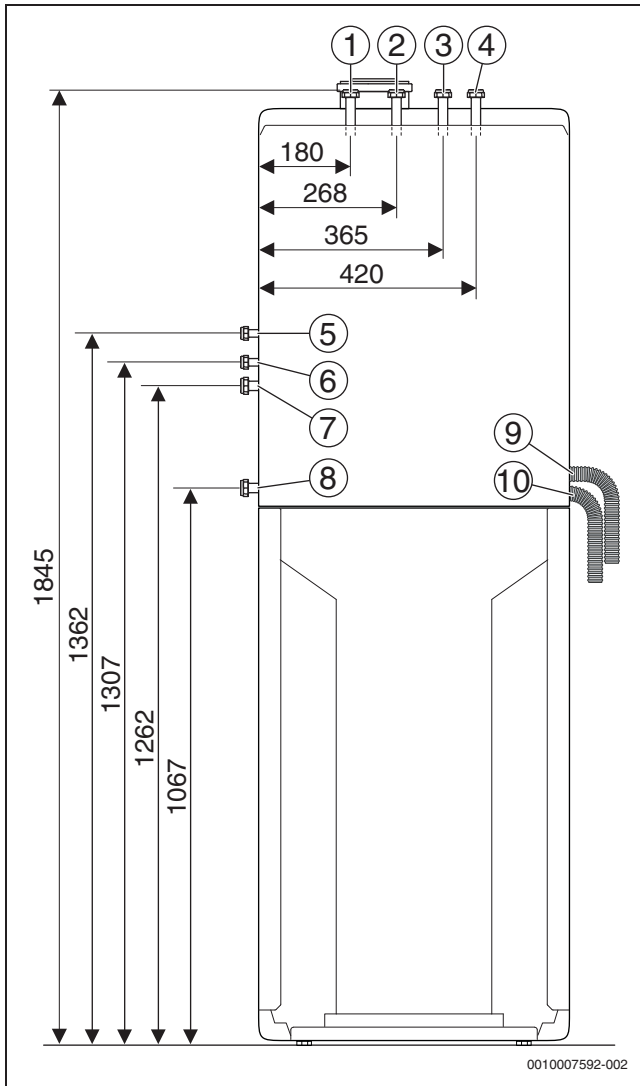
Připojovací rozměry se sadou pro jeden otopný okruh (rozměry v mm)
